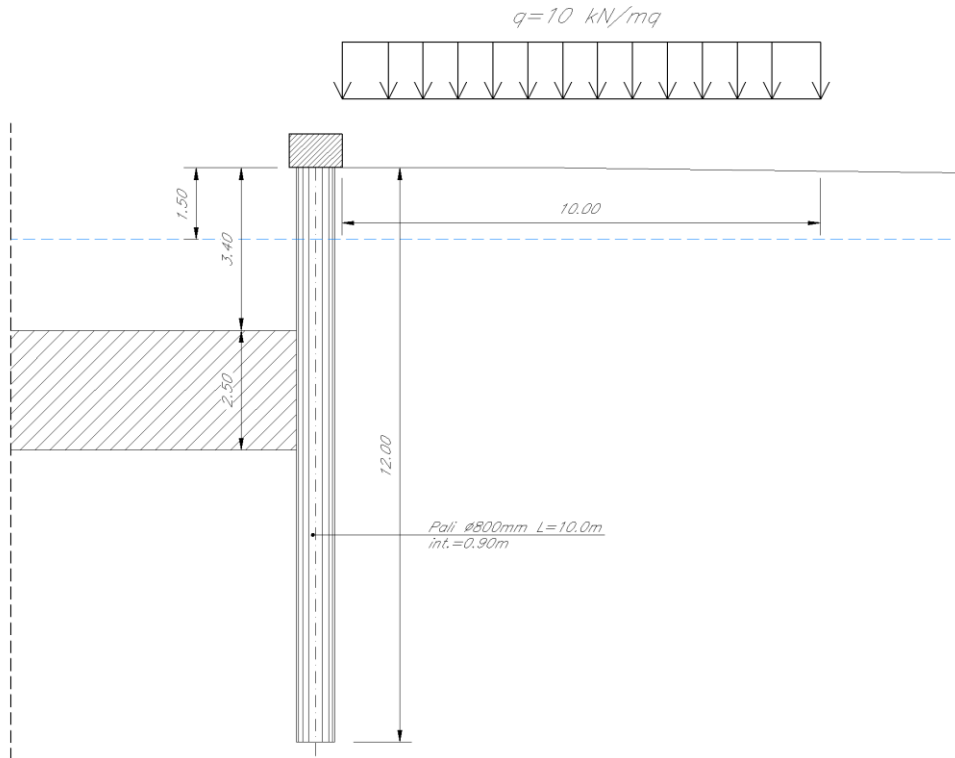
Pila 3 - sez.1: modello di calcolo
